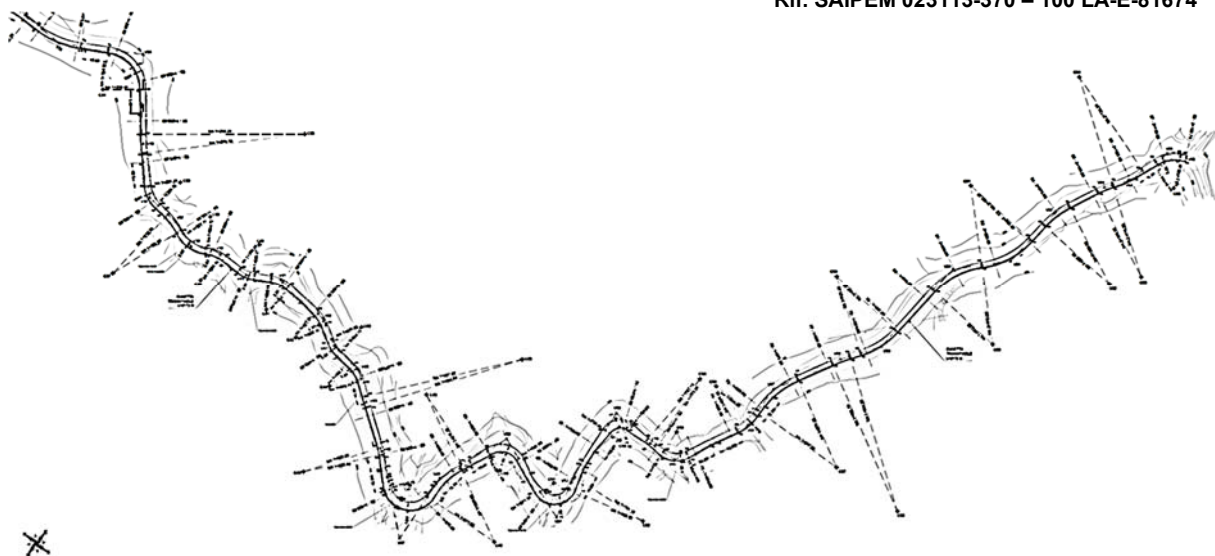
Sviluppo planimetrico della strada ID24 – Parte2
